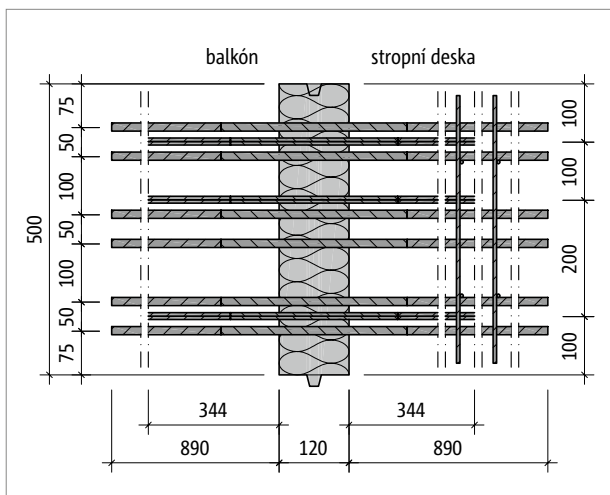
Schöck Isokorb® XT typ DP-MM1-VV1: Půdorys
